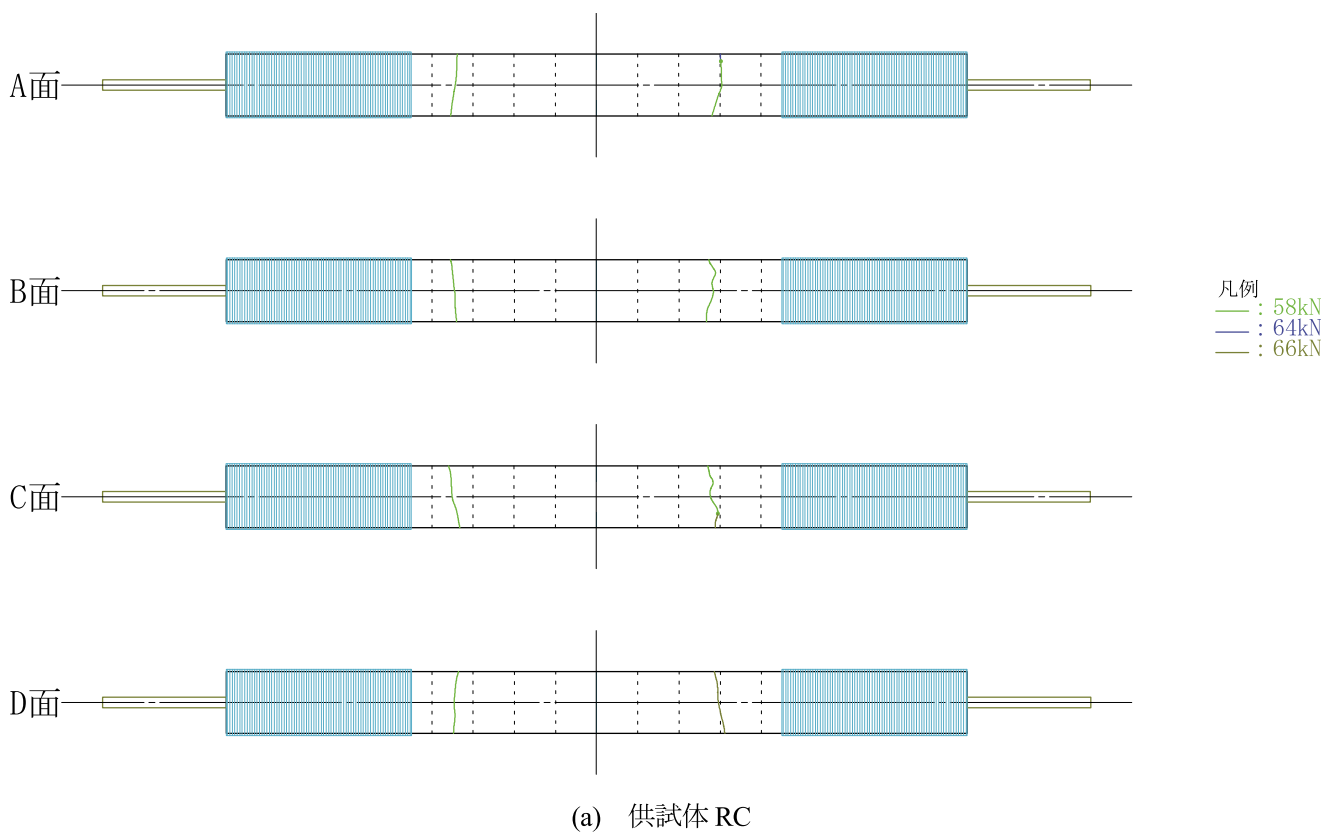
ひび割れ発生時におけるコンクリートのひび割れ発生状況
